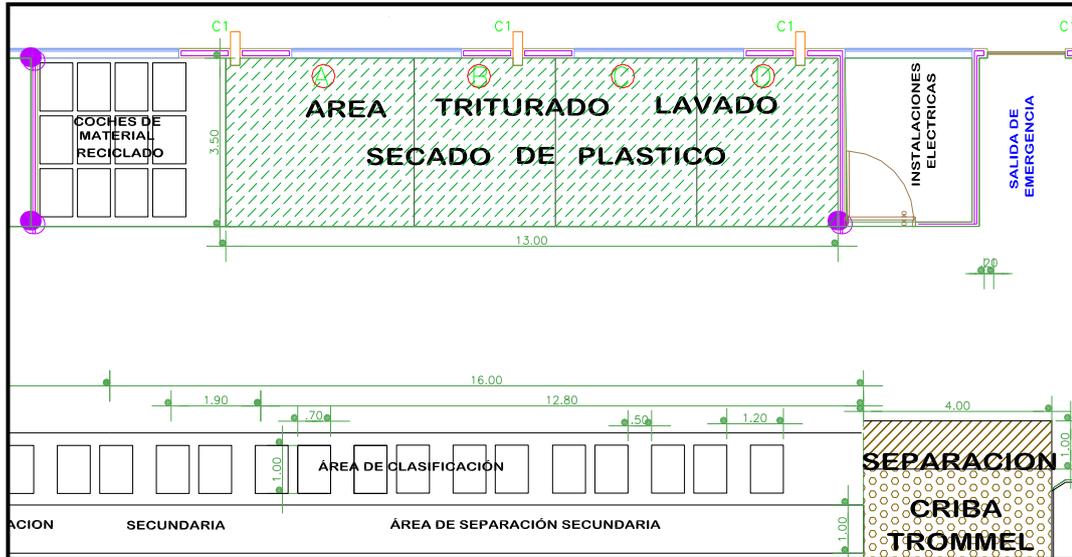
Vista arquitectónica del área general de lavado, triturado, secado de la planta de reciclaje.
